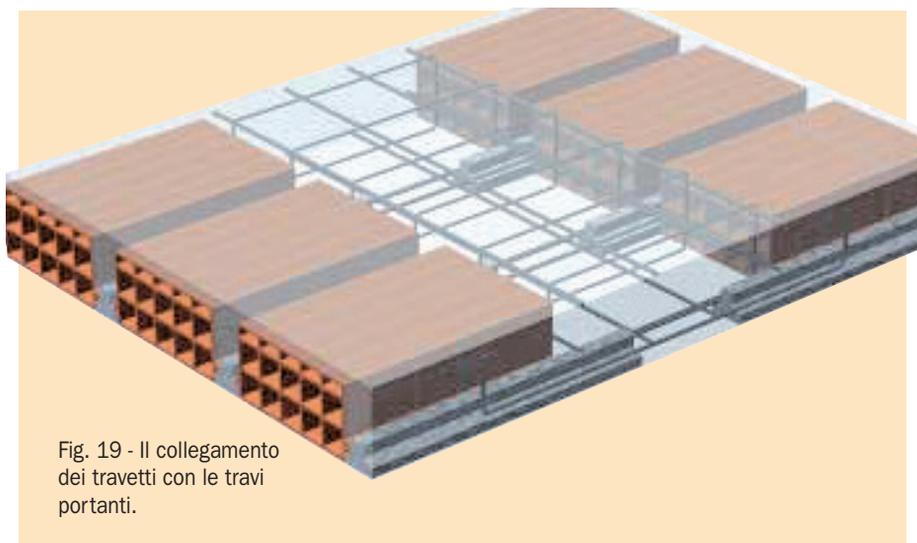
Il collegamento dei travetti con le travi portanti.
